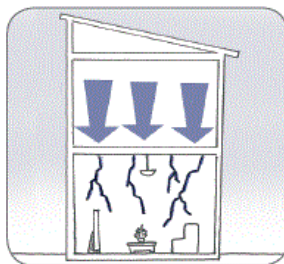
Fissuras na alvenaria causadas por sobrecarga vertical distribuída [29]
